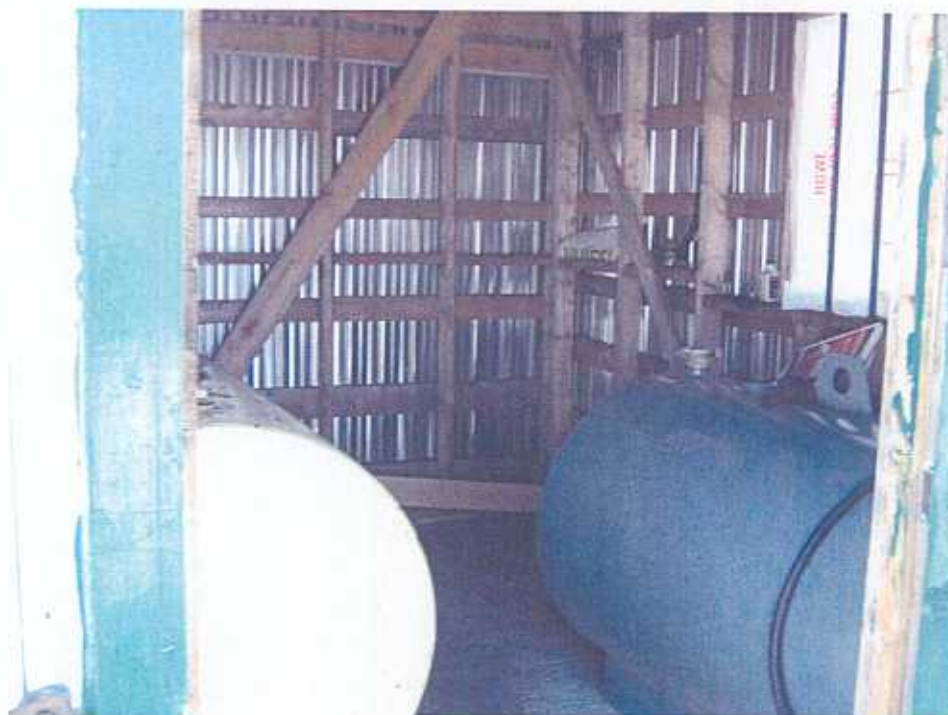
Site d'entreposage intérieur sur dalle de béton d'essence et de diesel
